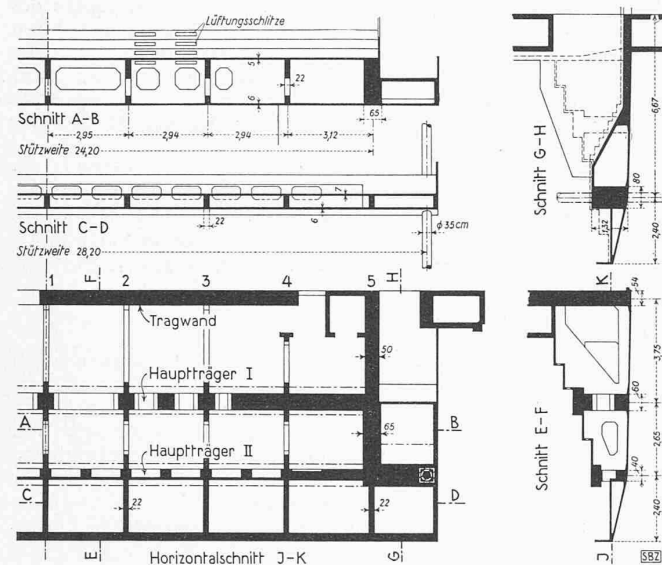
Hauptgalerie, Grundriss und Schnitte 1 : 250
